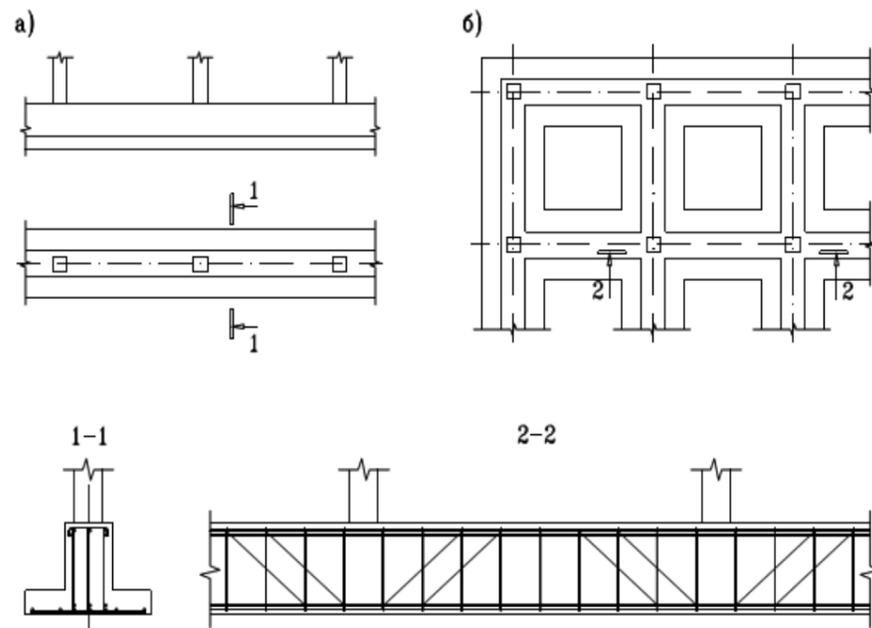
Ленточные монолитные фундаменты под колонны; а – отдельные ленты; б – перекрестные ленты.
